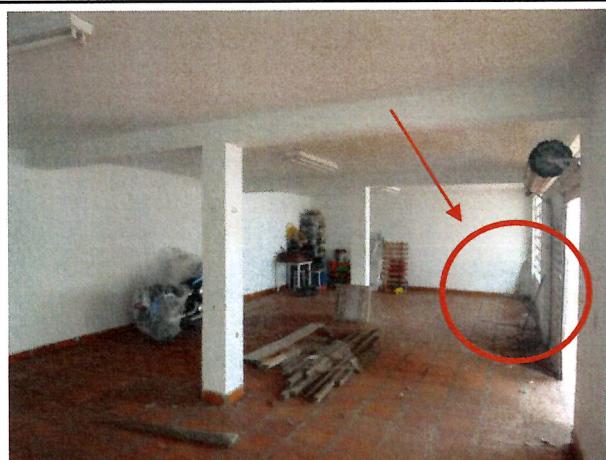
Vista geral do abrigo de veículos, no detalhe pontos de infiltrações
